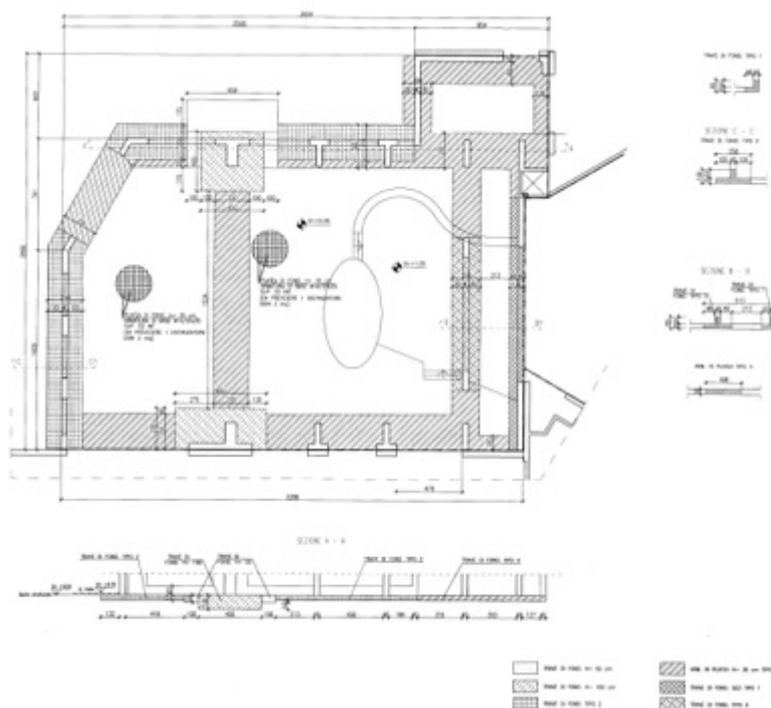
Carpenteria fondazioni (Progetto originale delle strutture oggetto di demolizione – BLOCCO C).
